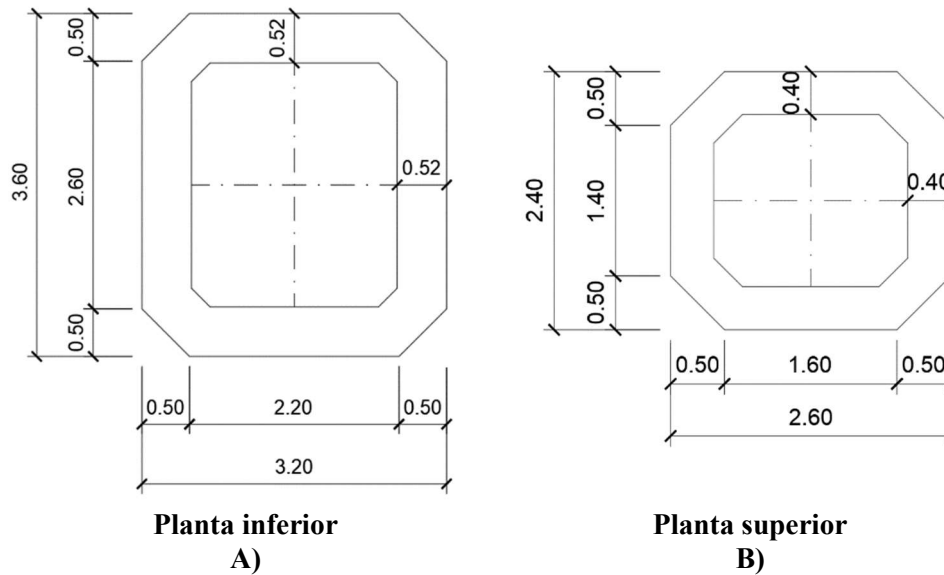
Vista en planta de las secciones inferior y superior de la columna, respectivamente
